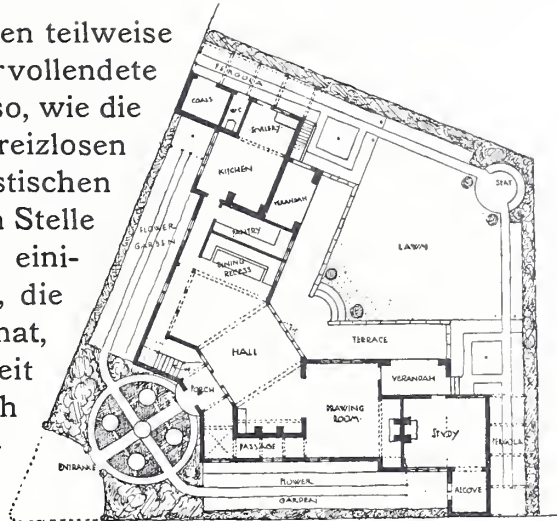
Garden Suburb Hampstead. Grundrißlösung eines Eckhauses, Architekt: M. H. Baillie Scott
